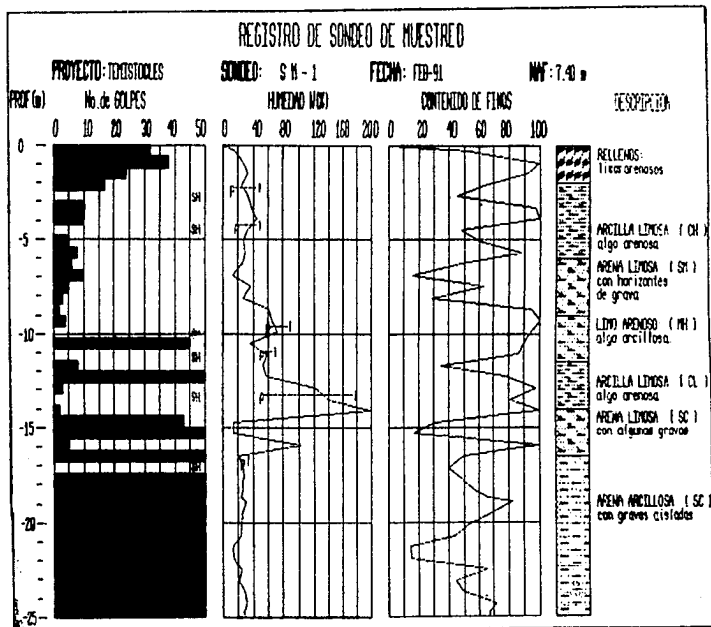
PERFIL TIPO DE ZONA II (TRANSICION).¹
